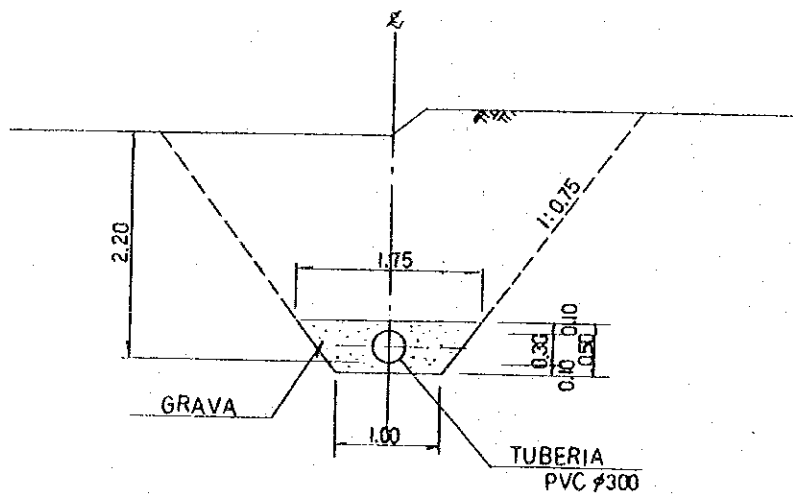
Sección de Drenaje Sub-colector Entubado
